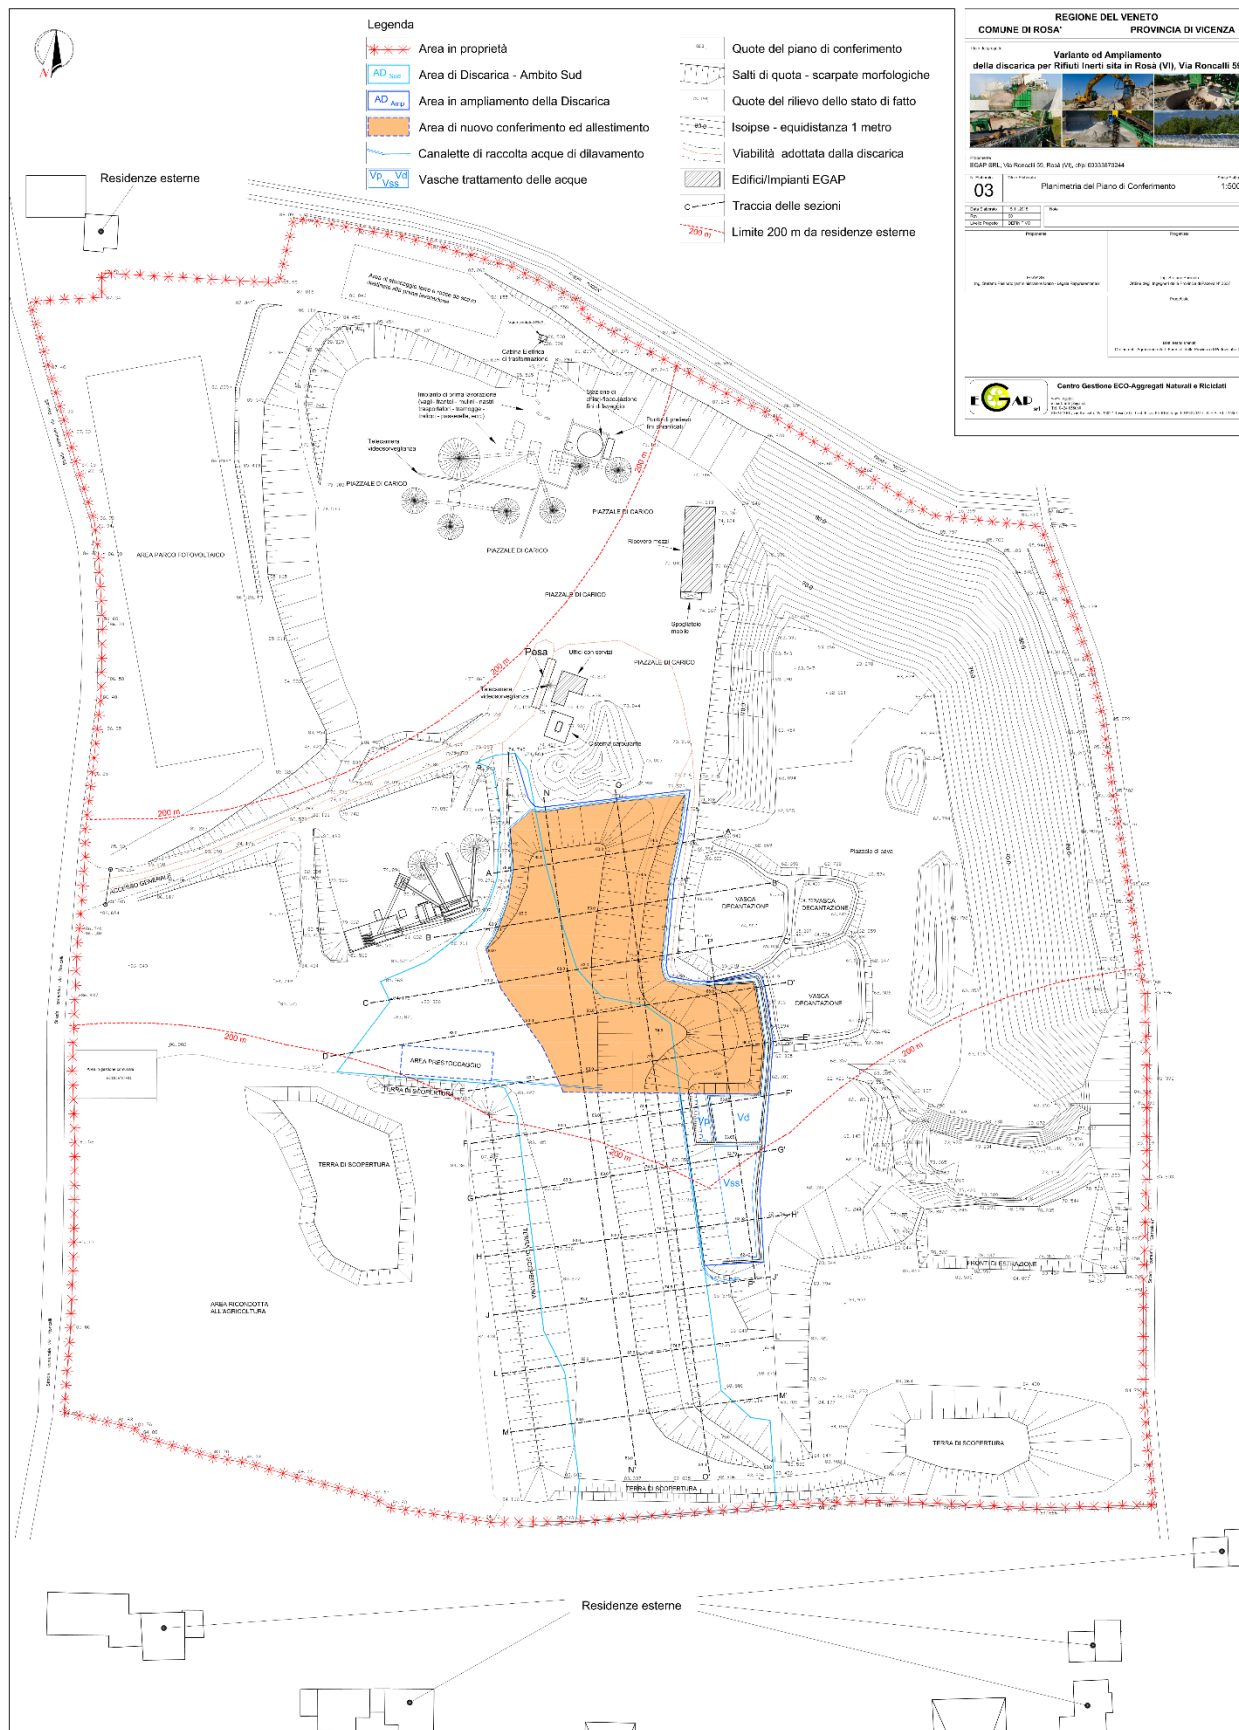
Area di Discarica Finale AD' a conclusione dei conferimenti. Elaborato n. 03 – PLANIMETRIA DEL PIANO DI CONFERIMENTO
